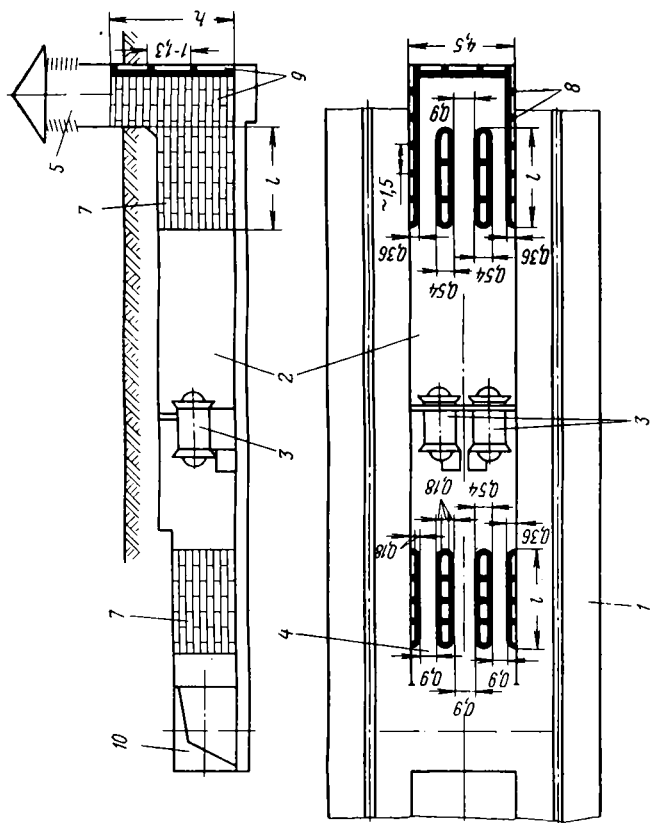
Схема размещения пластинчатых глушителей шума из бетонных шумопоглощающих блоков в вентиляционной установке тоннельной вентиляции, расположенной на перегоне мелкого заложения метрополитена на уровне и между путевыми тоннелями:
